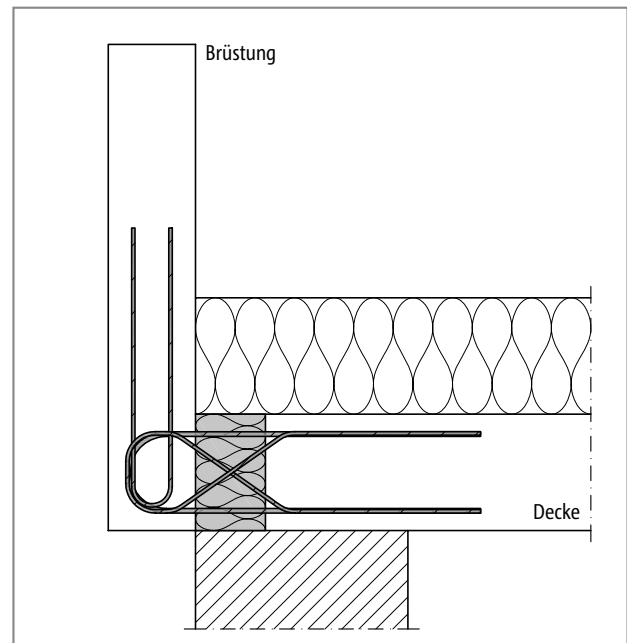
Schöck Isokorb® XT Typ F: Anschluss einer frontal angeschlossenen Brüstung bei wärmedämmendem Mauerwerk
